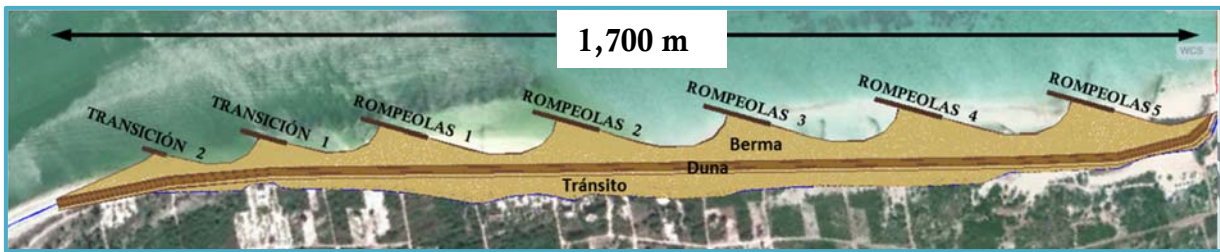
Plano de las obras a implementarse en la Zona Suroeste.
